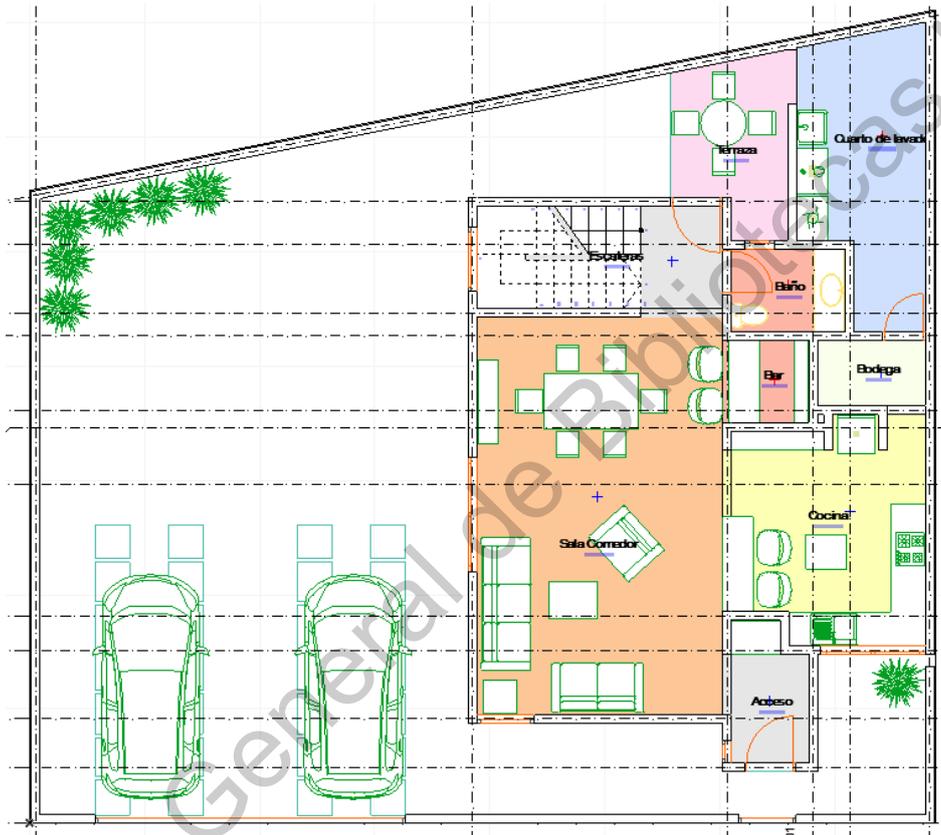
Zonas/Habitaciones en Planta baja del proyecto 001.
